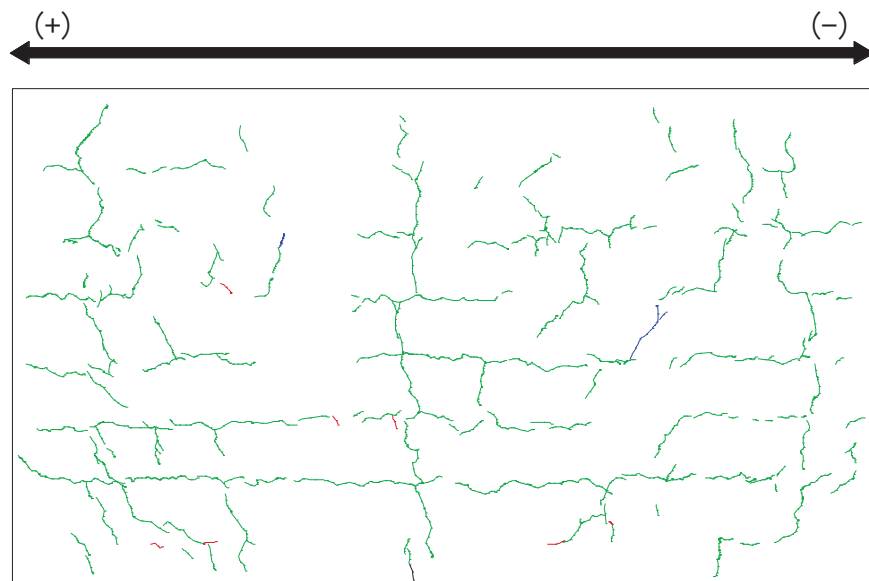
(2) 乾燥試験体 [2] 1/10000rad. におけるひび割れ図
